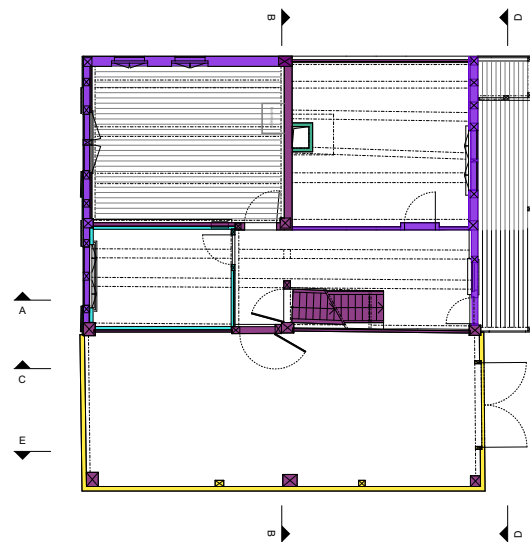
Grundriss 1. OG Bauphasenpläne
